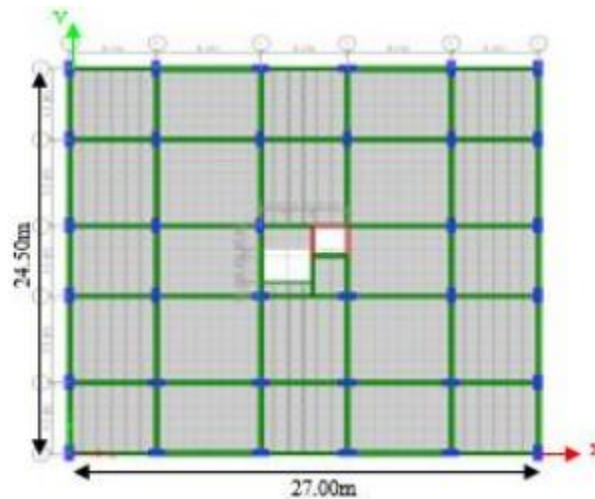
Planta de edificaciones con sistema tradicional aporcionado
